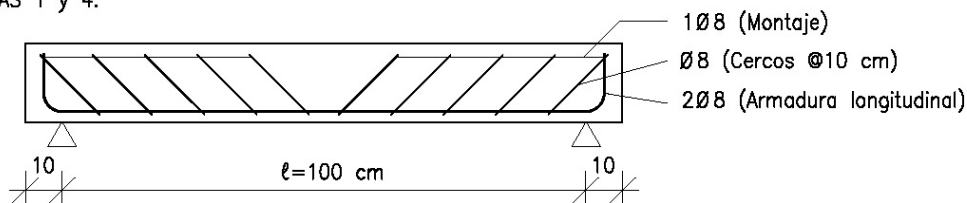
Armados y encofrados de las vigas para ensayar a flexión.
